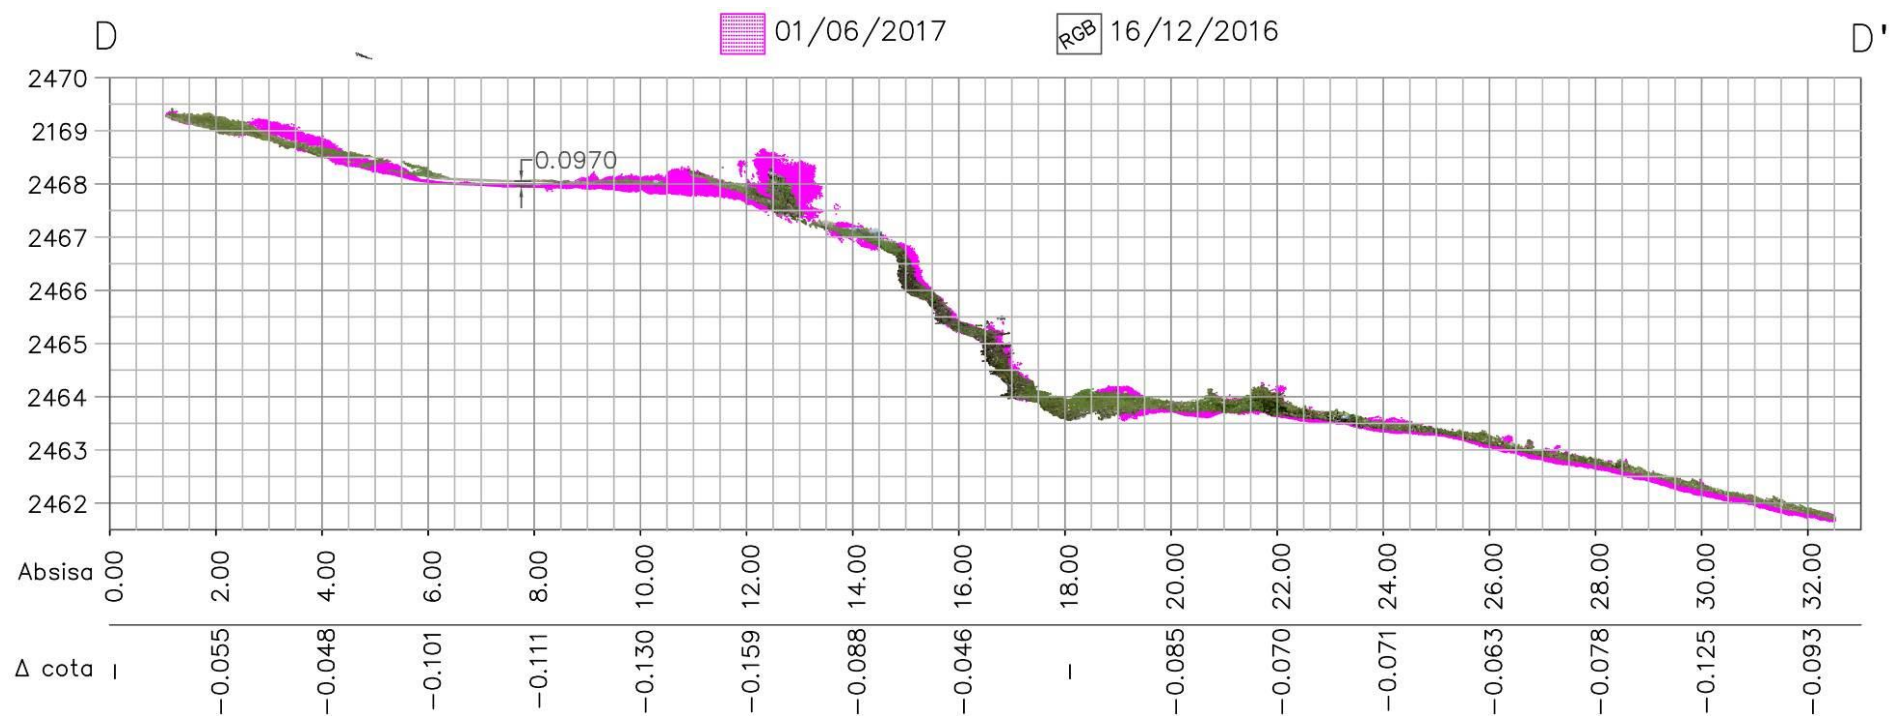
Levantamiento 1 vs levantamiento 2, perfil D-D'.
